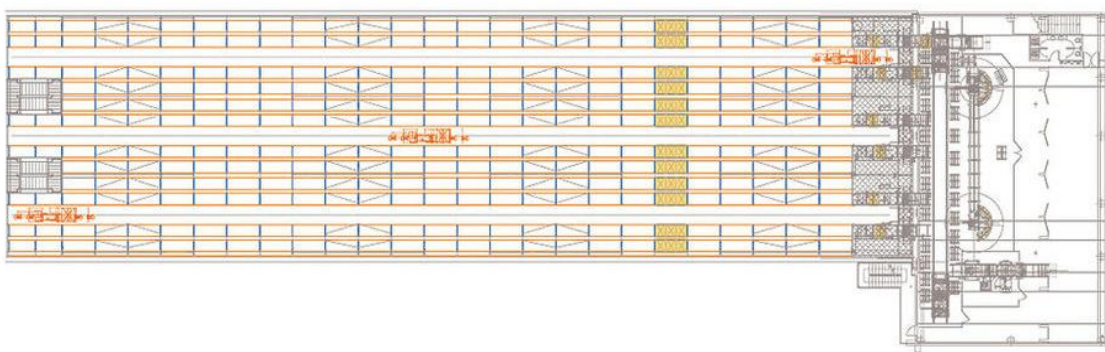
Distribución en planta de un sistema de almacenamiento automático
